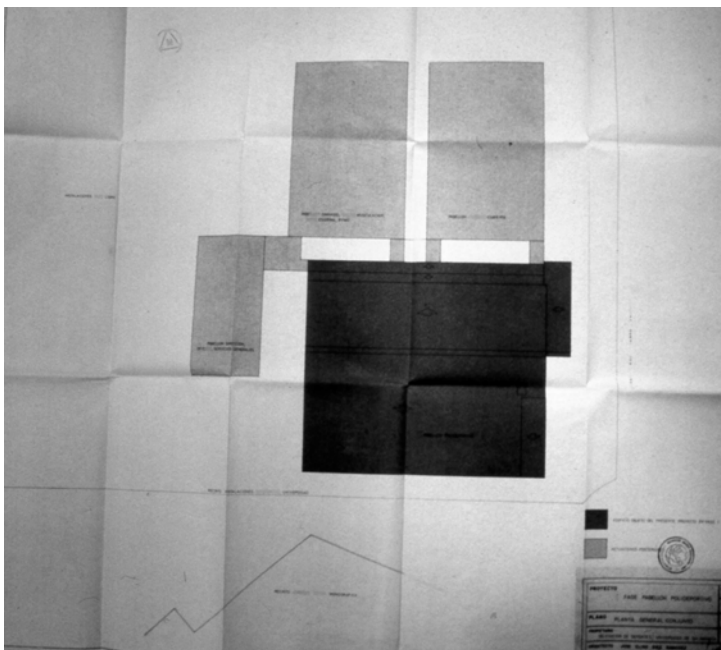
Pabellón Polideportivo: planta general, por J. E. Díez Sánchez, junio 1978.
